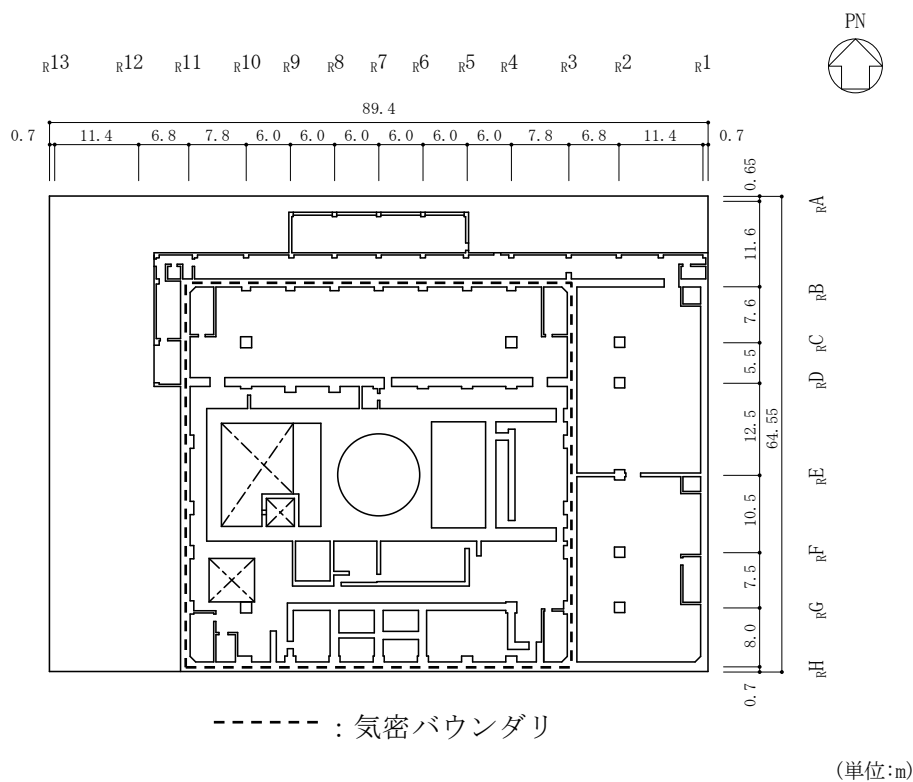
(6) 原子炉建物原子炉棟（二次格納施設）の概略平面図（EL 34.8m）
